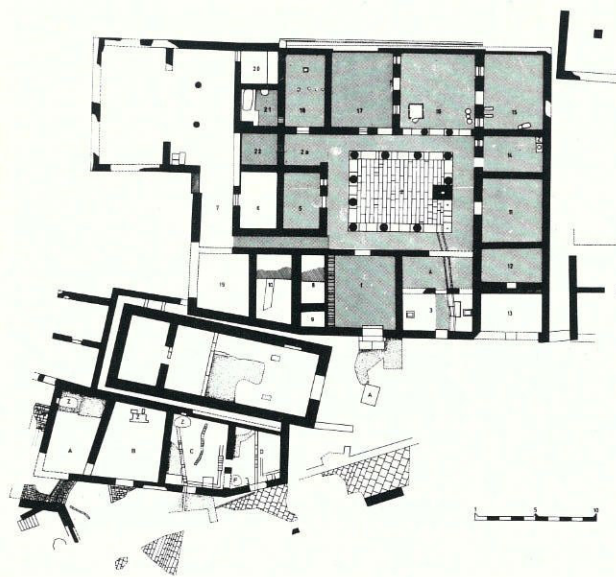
Casa a peristilio, pianta schematica 1987.
